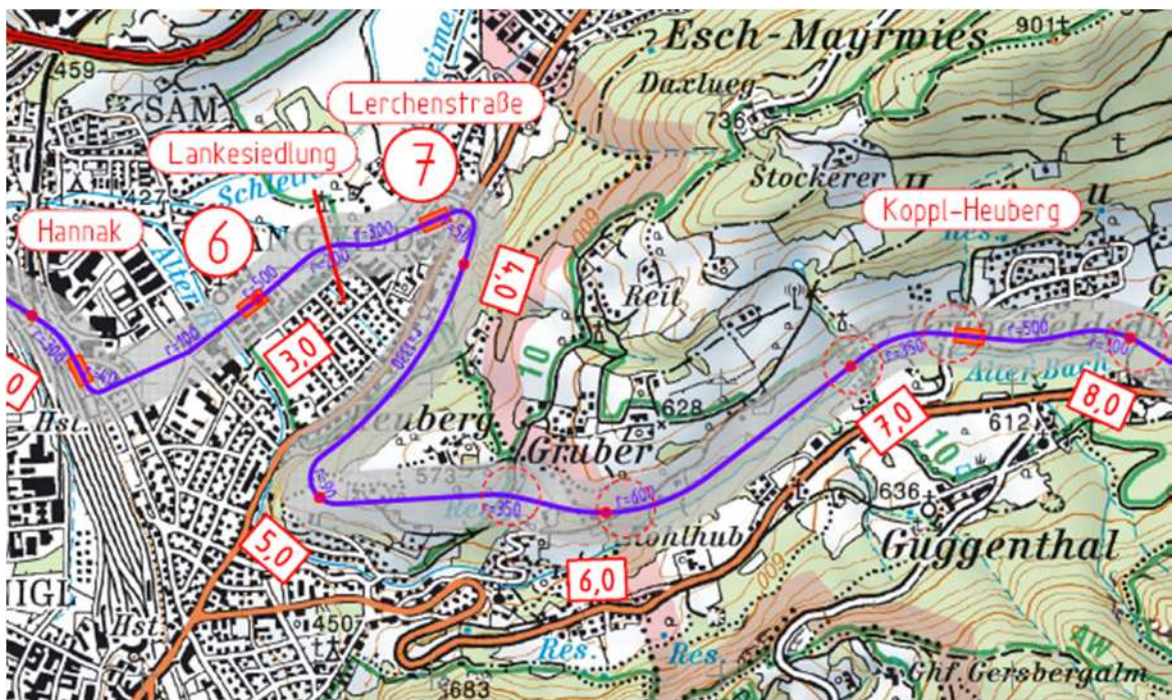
Lageplanausschnitt o. M. mit Kilometrierung und Stationen im Bereich Heubergaufstieg
